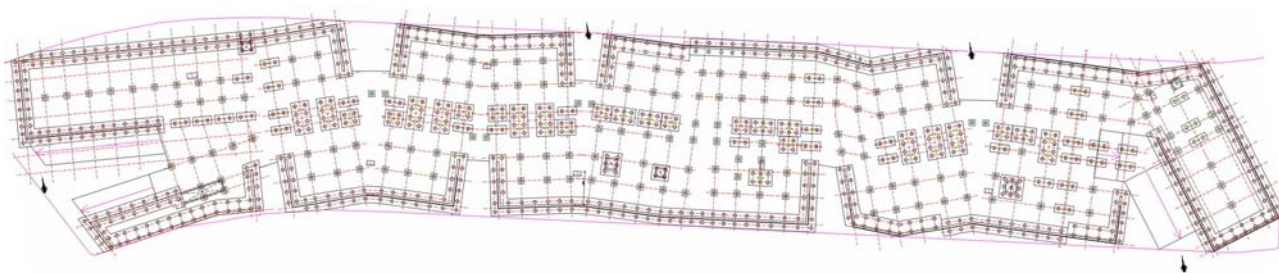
Vista en planta de la cimentación de las Escuelas de Artes y de Diseño
